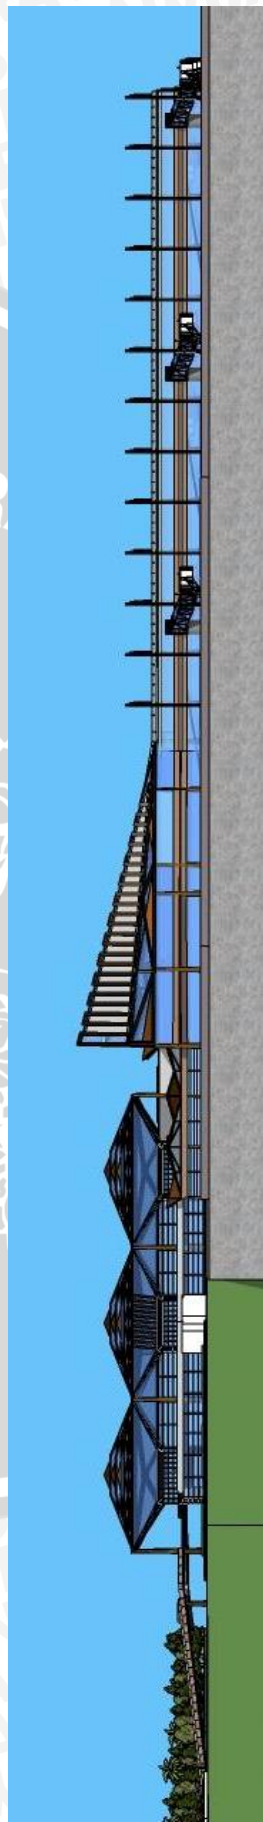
Tampak Kawasan Terminal Alternatif 1
